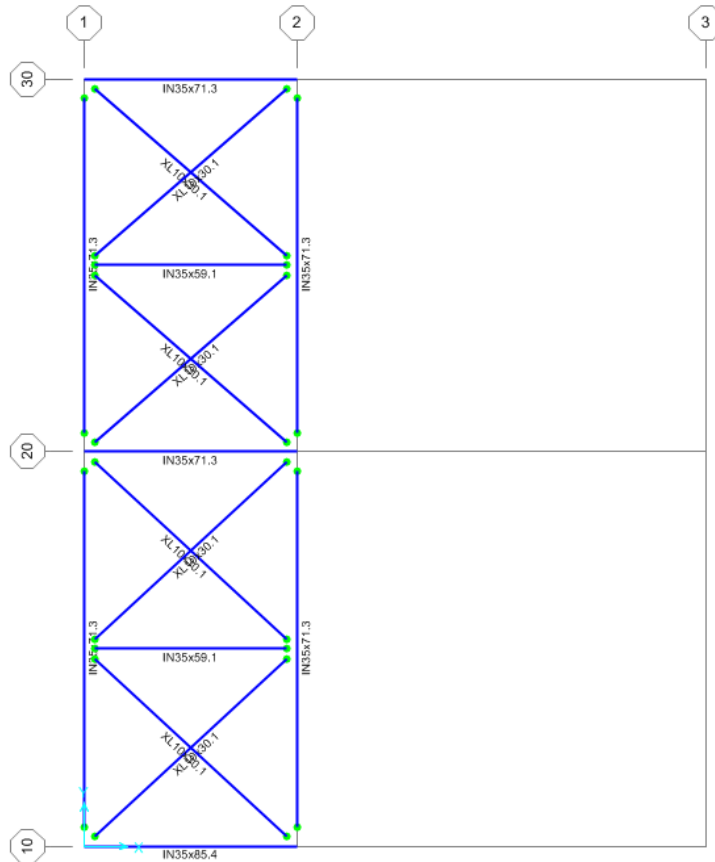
Planta Elevación 5.8 m sobre el nivel de terreno.
